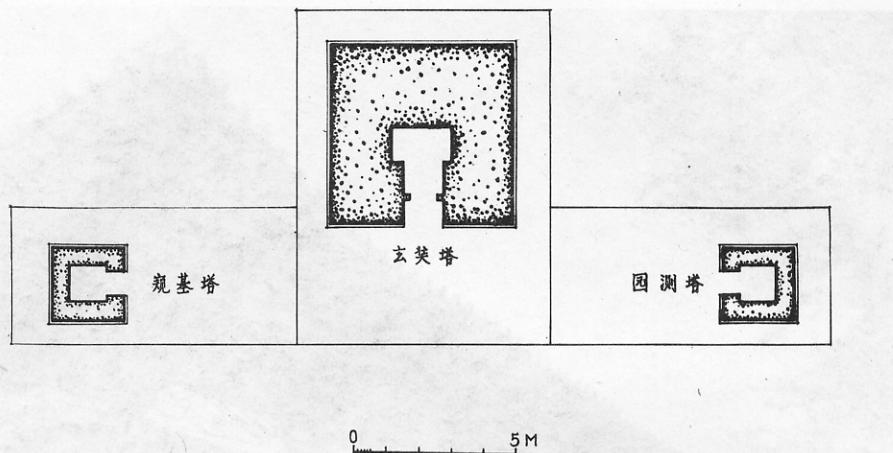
陕西西安市兴教寺玄奘法师墓塔平面图
